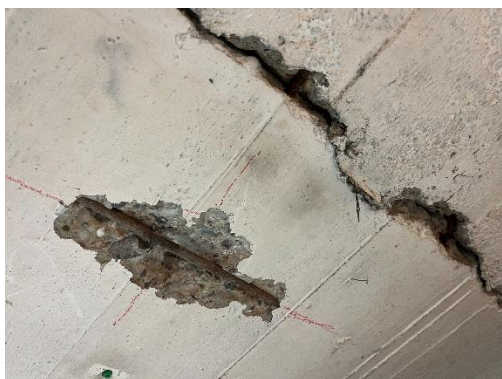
Dalle en béton armé d'aciers ronds lisses en plancher haut du sous-sol.
